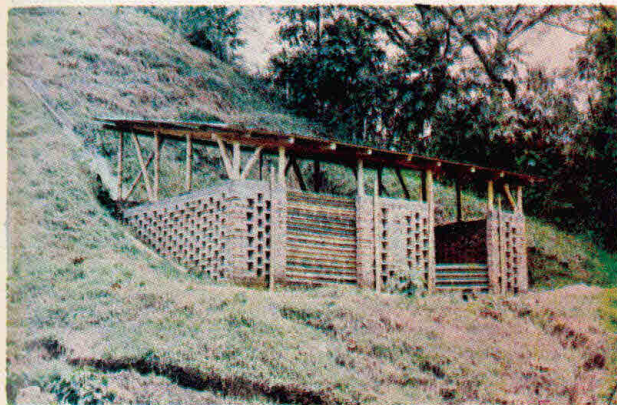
FOSA DE LADRILLO DE FACIL CONSTRUCCION. NOTESE EL APROVECHAMIENTO DE LA PENDIENTE PARA EL ARRASTRE DE LA PULPA.
